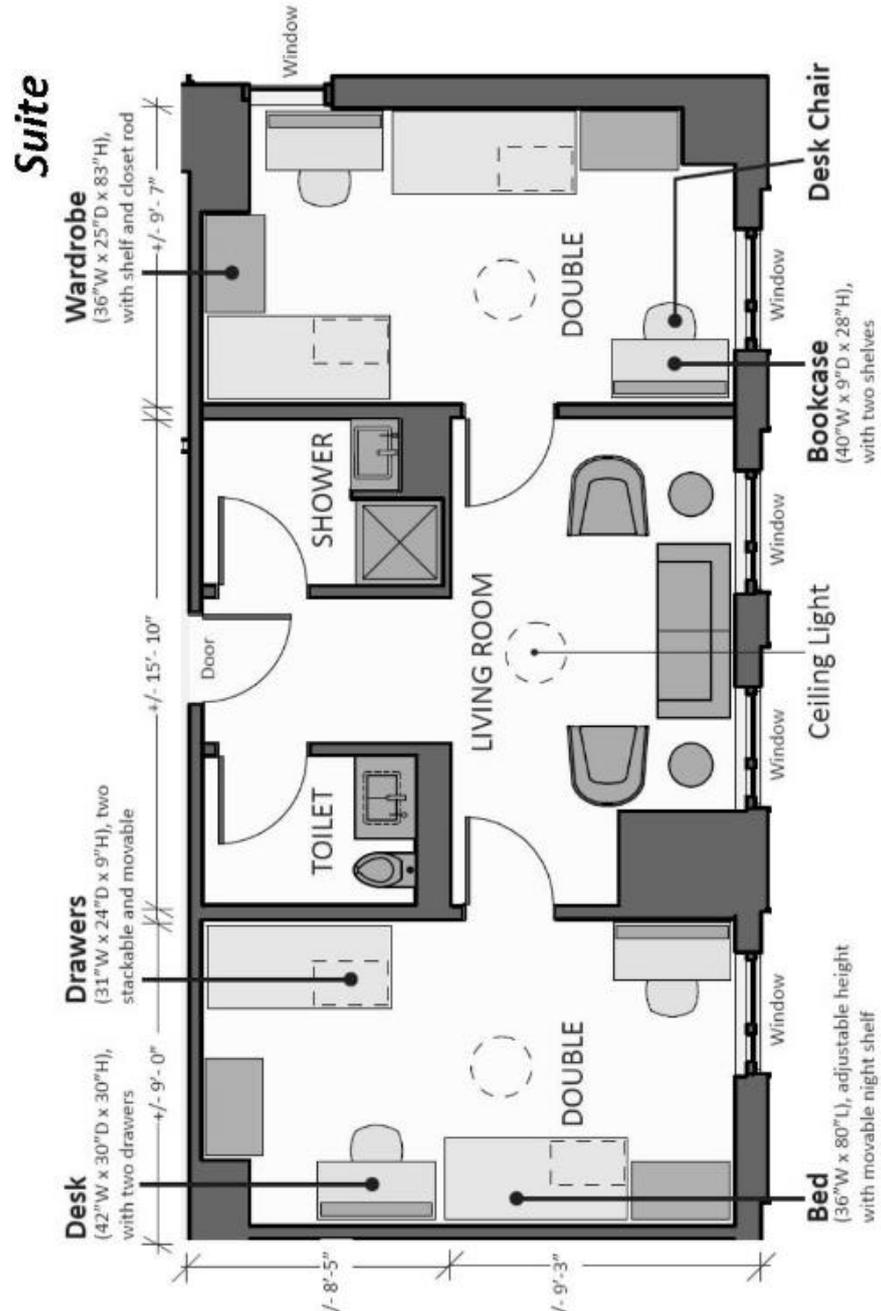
New England conservatory. Planta de departamento de dos habitaciones
